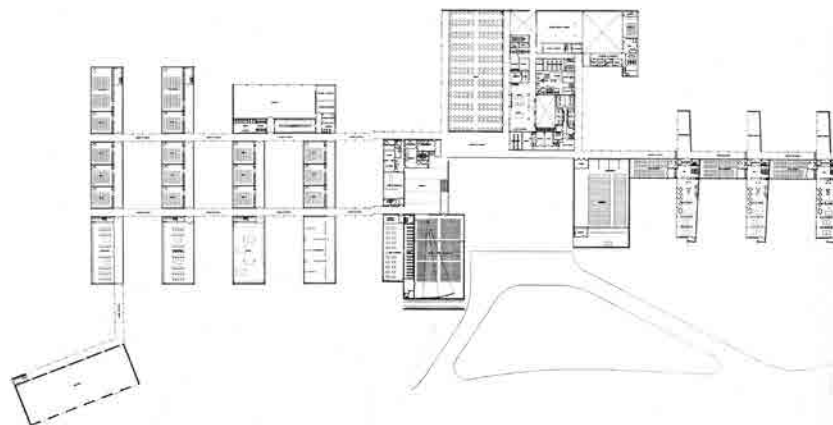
Plano general de planta de la Universidad Laboral de La Coruña.
